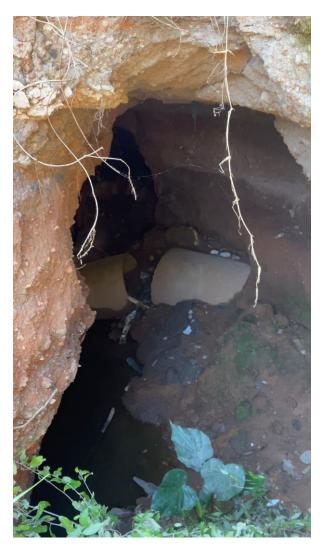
Detalhe do local da vistoria técnica onde é mostrado o tamanho exorbitante da erosão que se formou embaixo do pavimento – Jardim Ipanema
